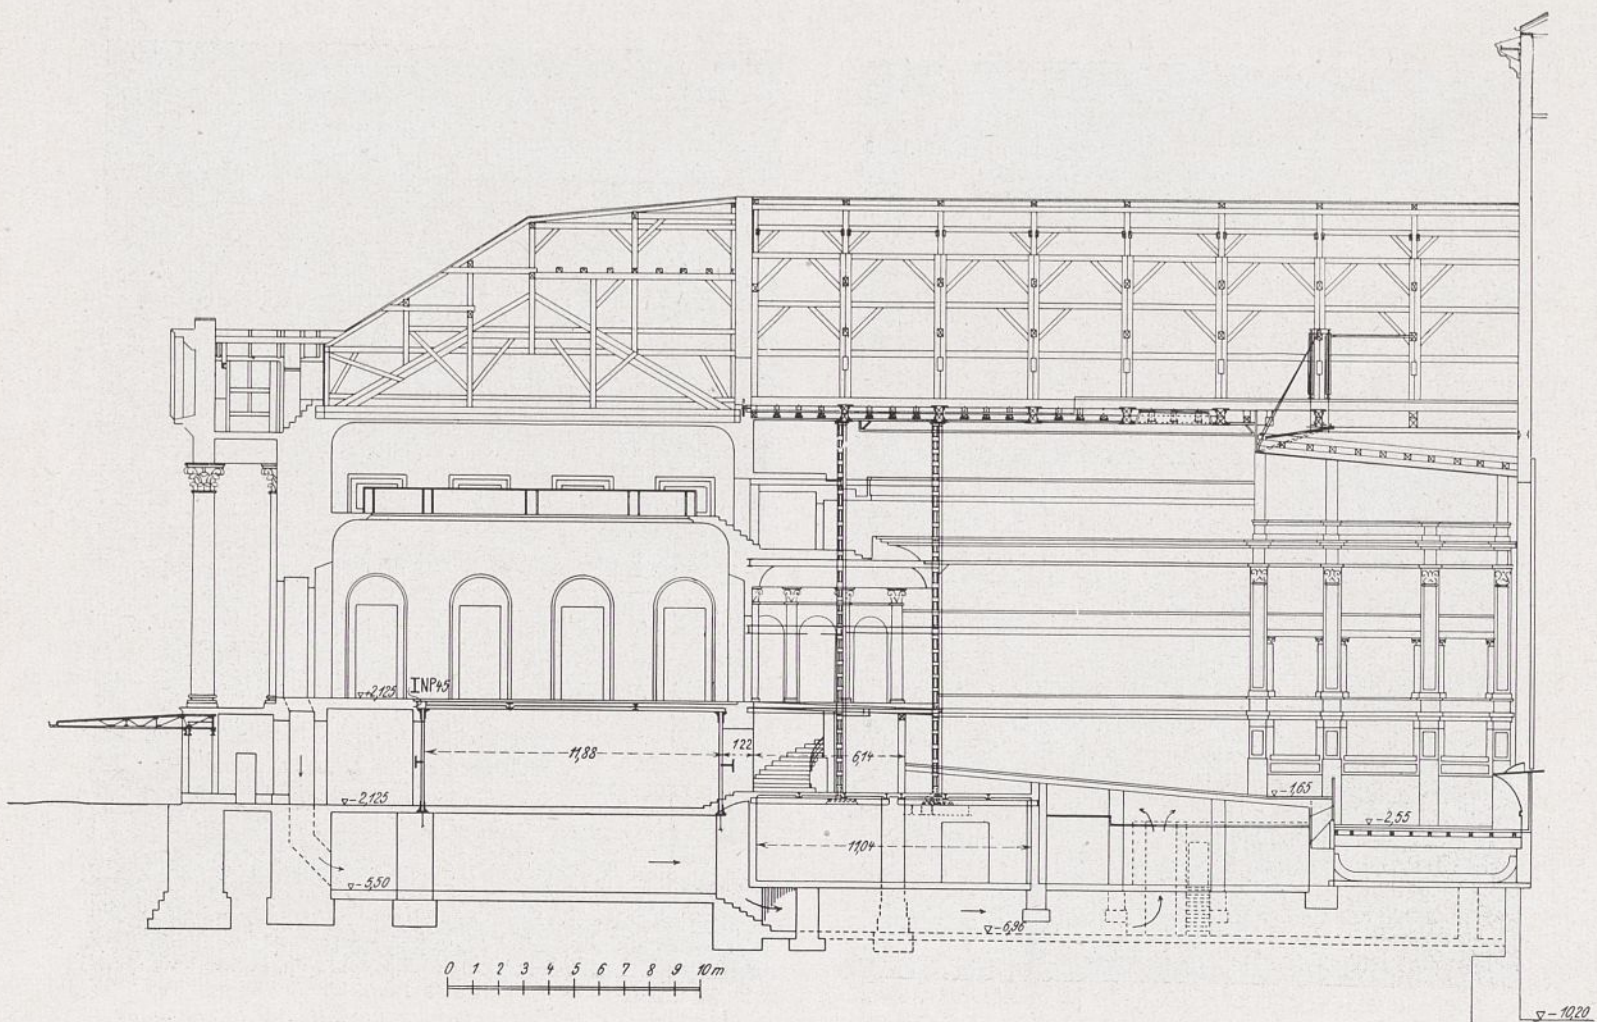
Eisenkonstruktion des Zuschauerhauses, Längsschnitt.
